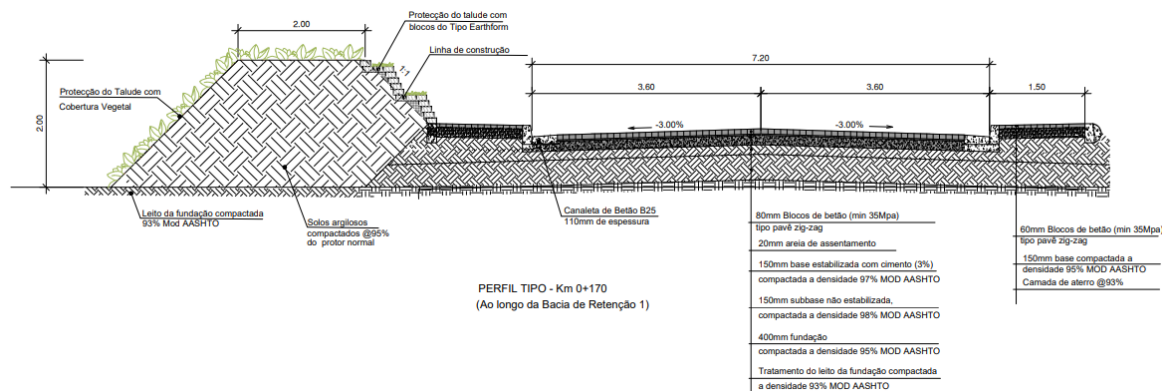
Perfil transversal tipo ao longo da bacia de retenção 1
